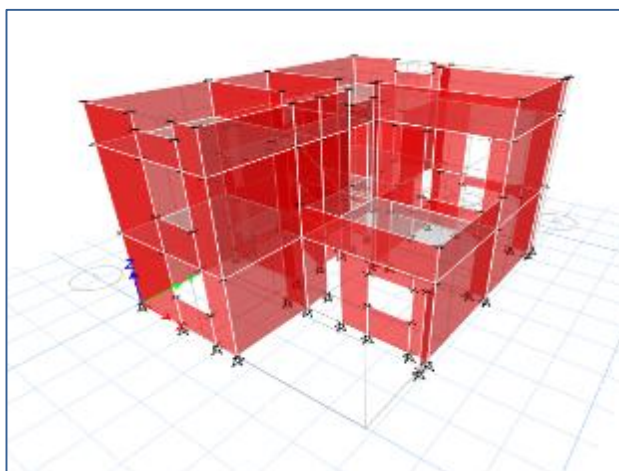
Vista Tridimensional de la vivienda con el sistema EMMEDUE
